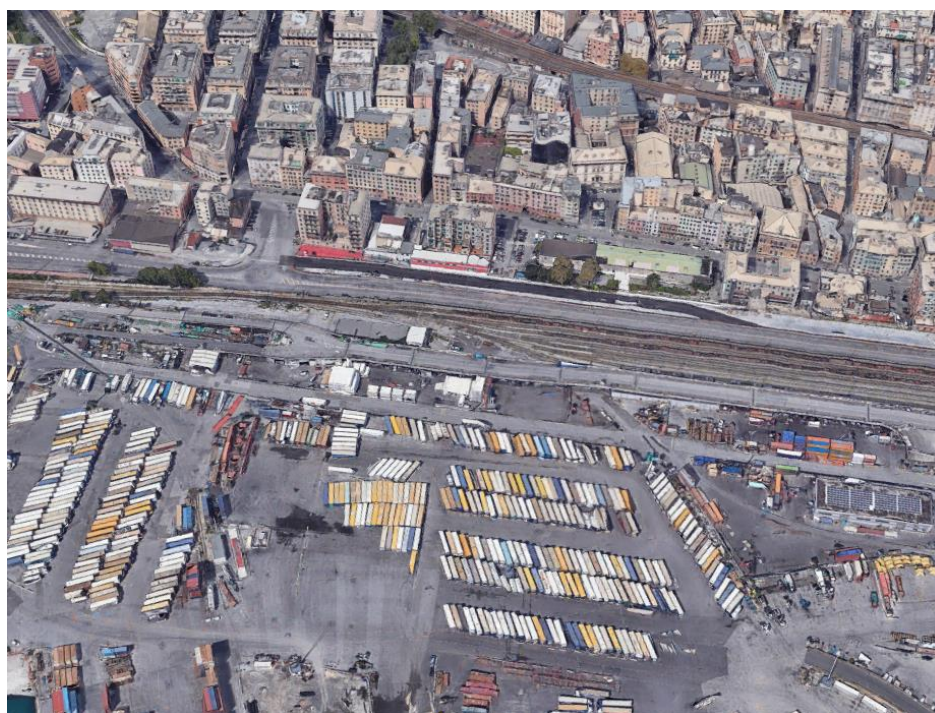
Stralcio planimetrico dell'opera oggetto di studio nel primo contesto ambientale
